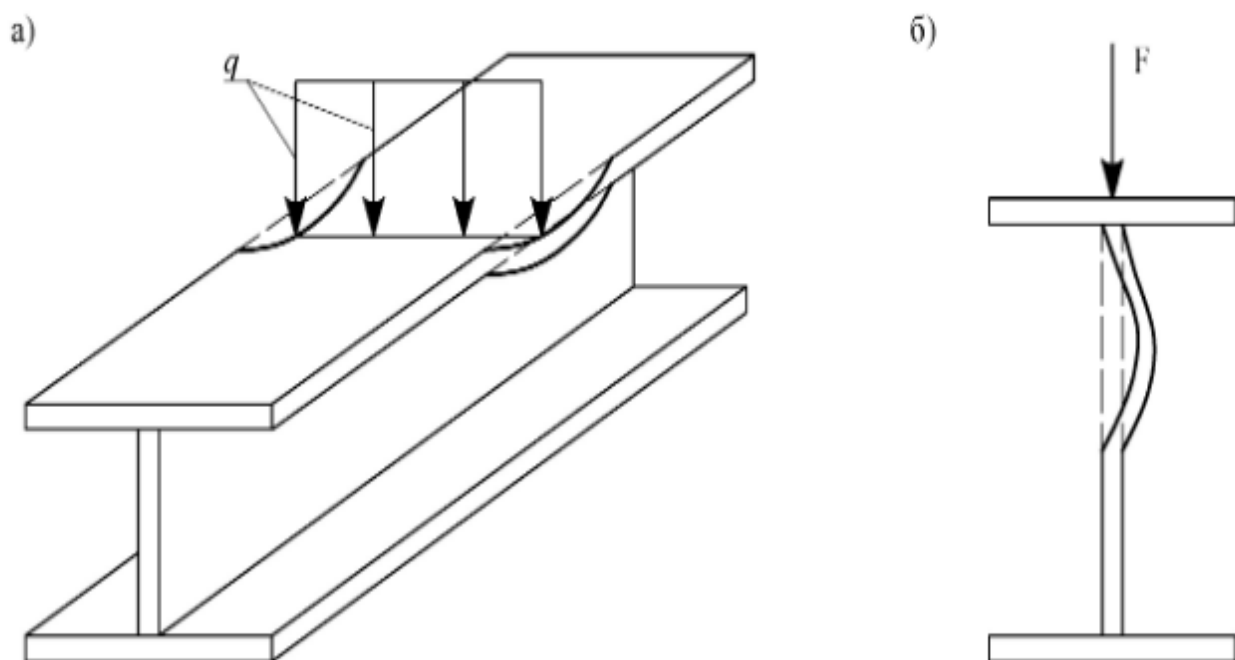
Схема дефекта - потеря местной устойчивости: а) полки сжатого пояса балки; б) стенки балки.
